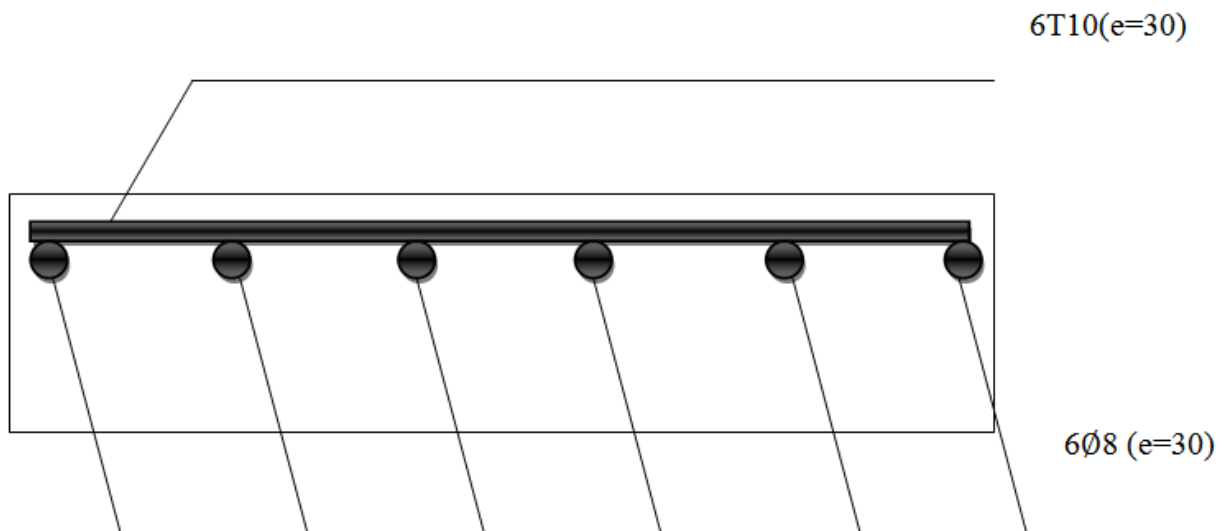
Schéma de ferrailage de l'escalier en appuis
